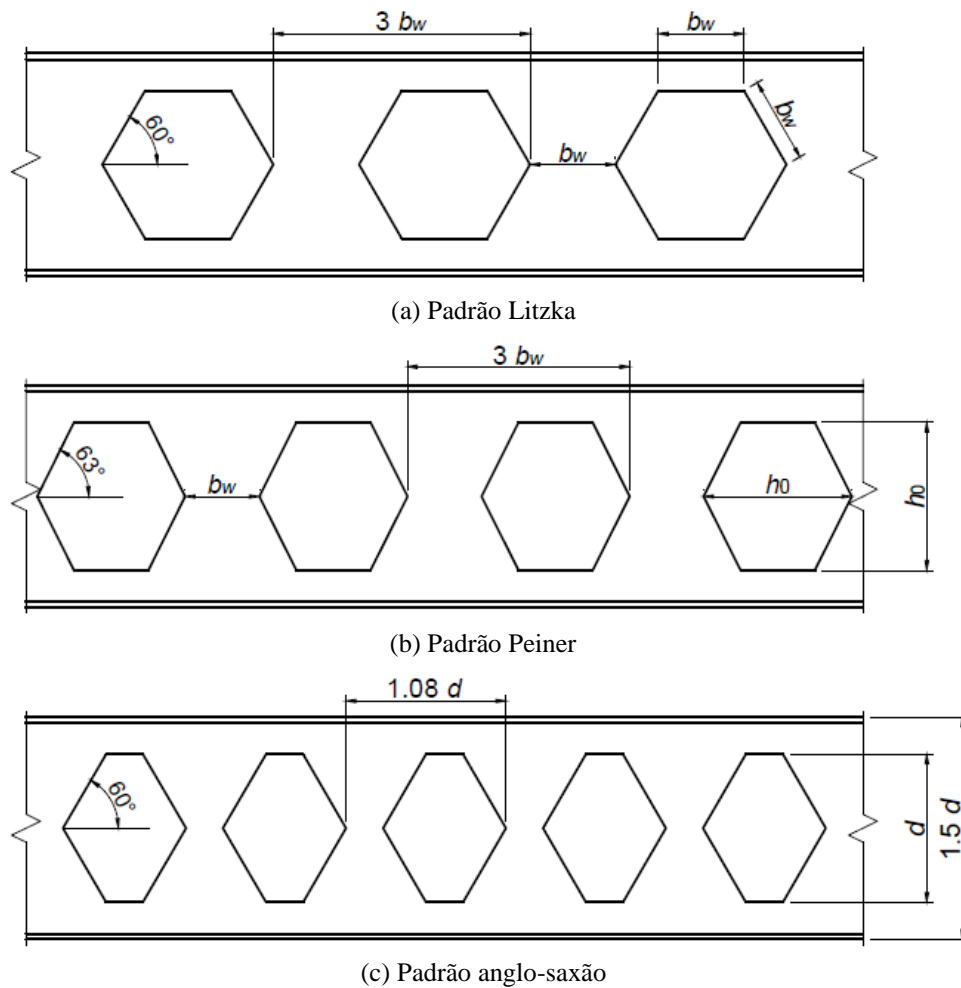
Esquema de fabricação de vigas casteladas.
